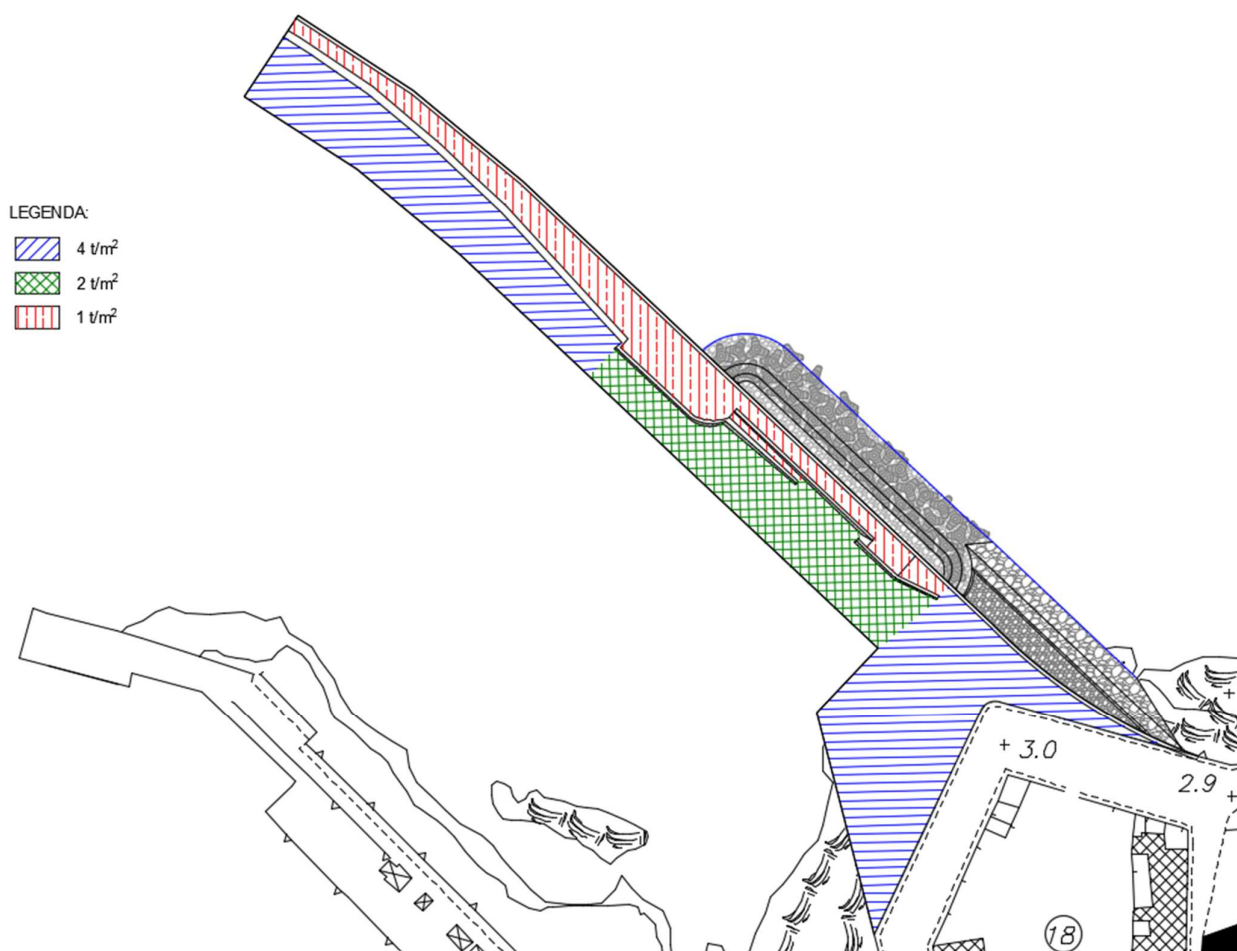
Planimetria con indicazione dei sovraccarichi di progetto
